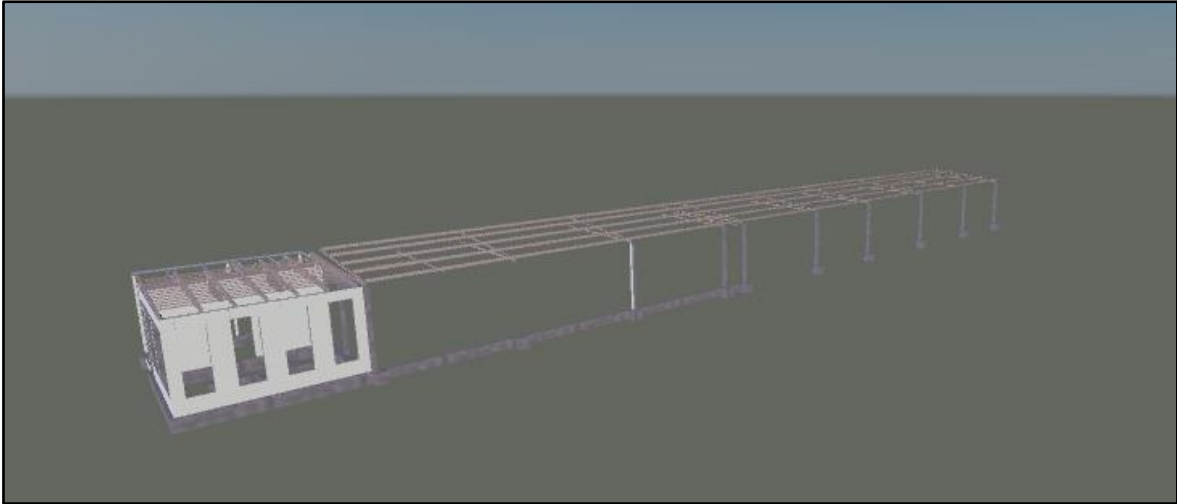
Vista lateral Laboratorio de Ingeniería.
